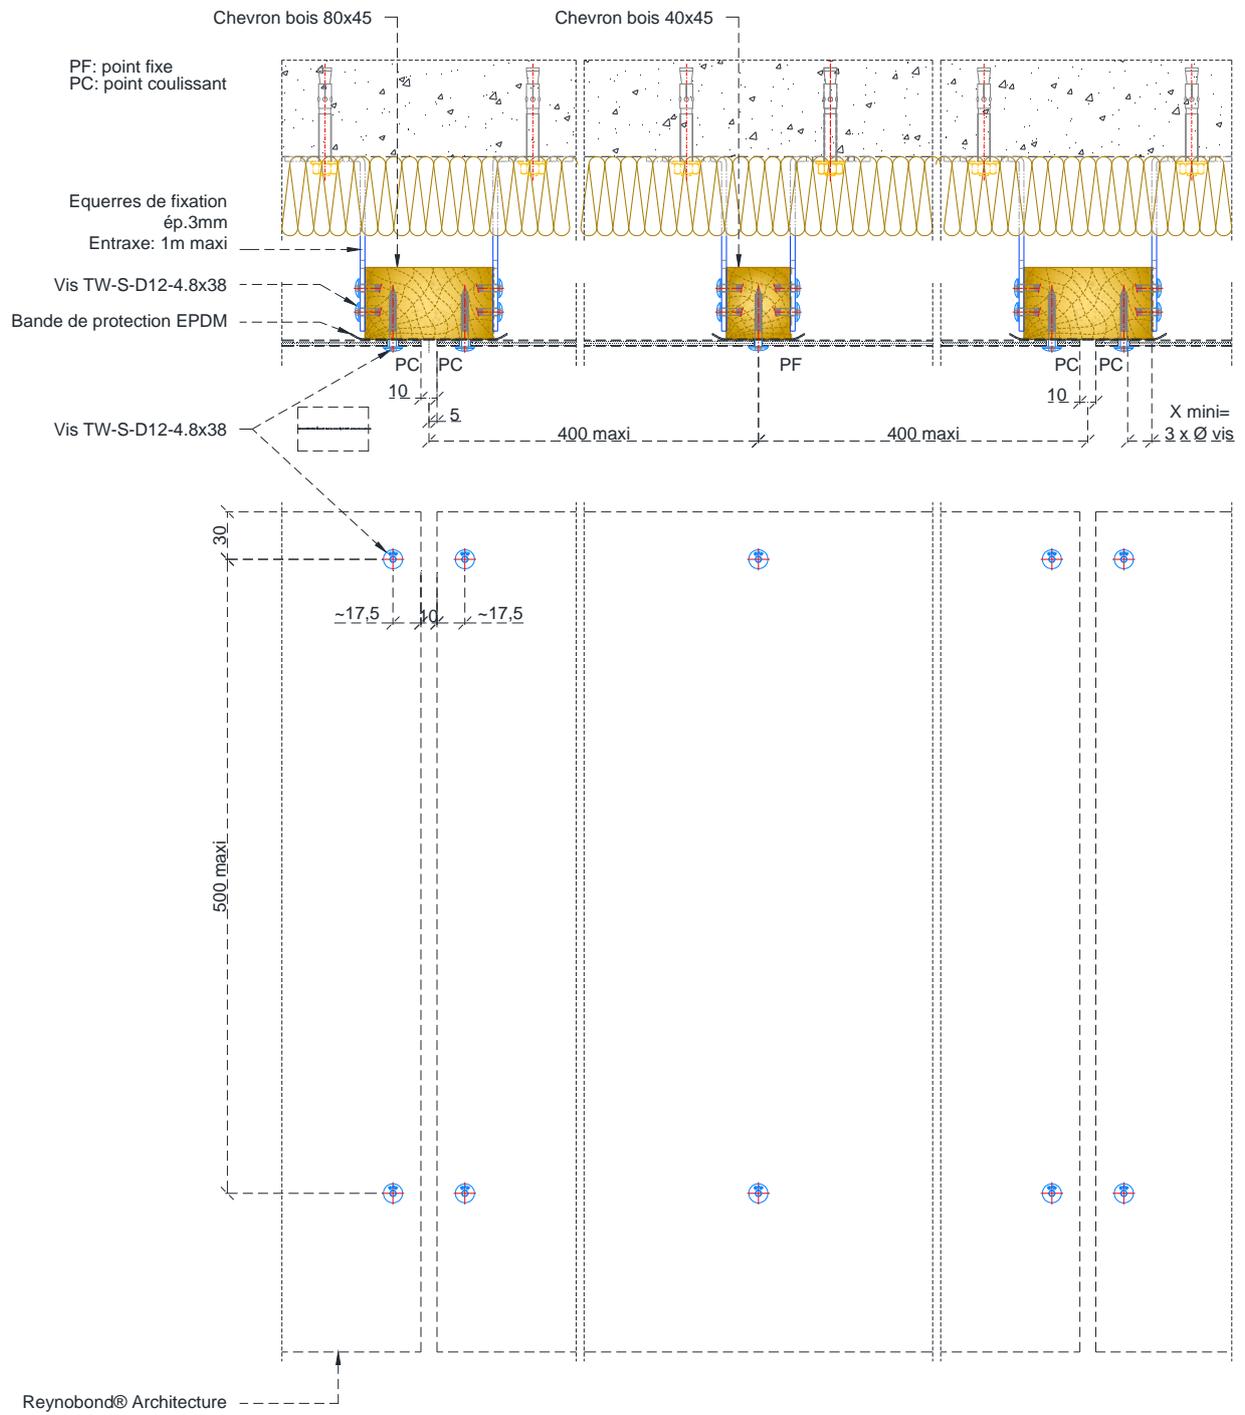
Pose en sous-face de dalle – Système vissé SW 2c
